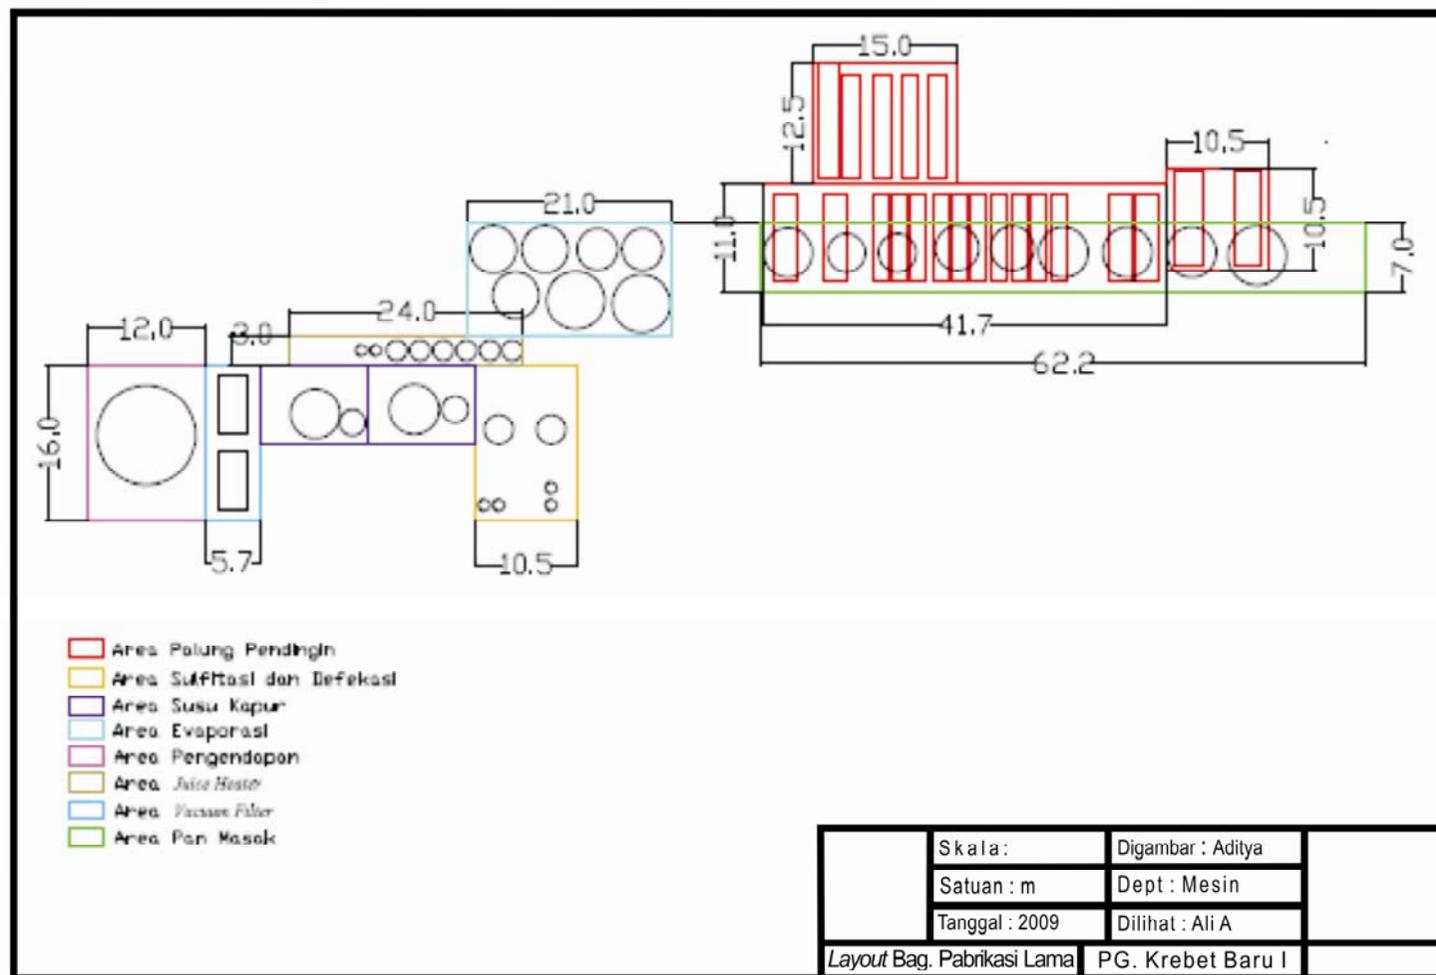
Plant layout PG.Kretbet Baru I
